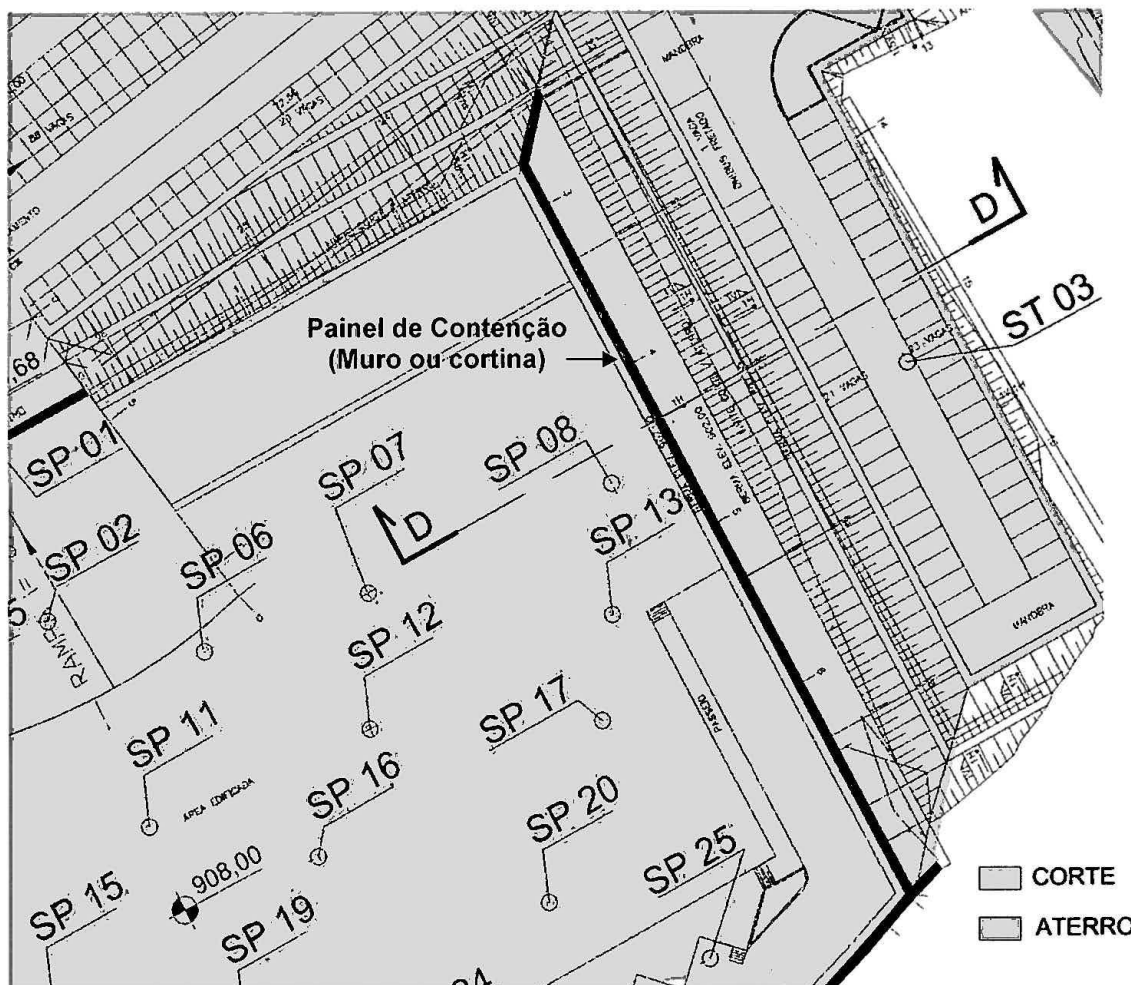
Estruturas de contenção a serem implantadas e definidas para a execução da terraplenagem local.
